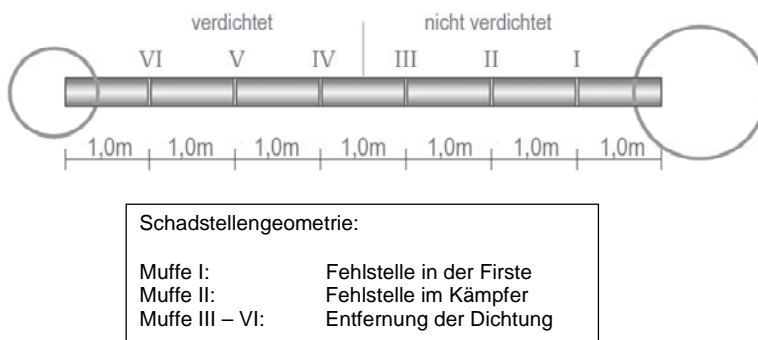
Sanierungsstrecke 3, Betonrohrhaltung
